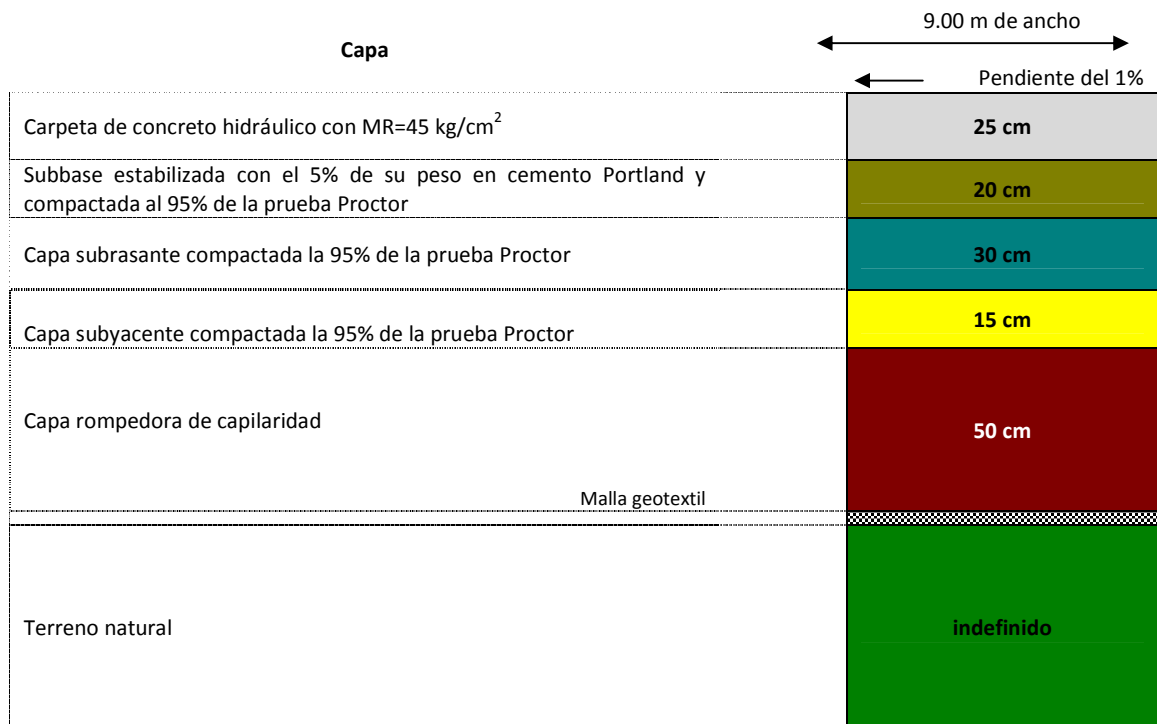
Sección transversal para el pavimento del tramo con capa rompedora de capilaridad.
